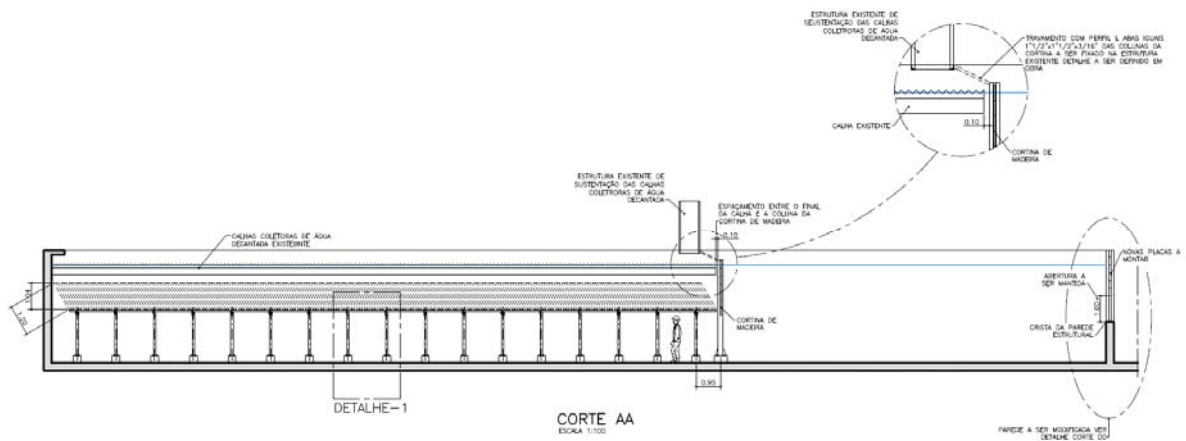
Posicionamento da estrutura suporte para a instalação dos módulos de sedimentação laminar – Corte geral de um decantador típico da ETA Anhangabaú
